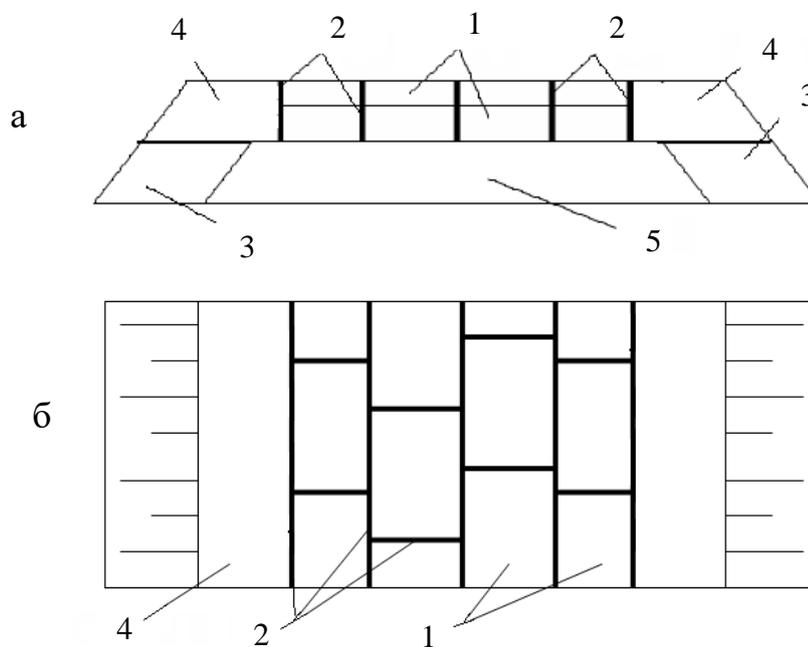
Дорожная одежда из плиты сборного покрытия из асфальтобетона, армированной не менее чем двумя слоями полимерной арматуры: а – поперечный разрез; б – вид сверху; 1 – плита сборного покрытия из асфальтобетона, армированной не менее чем двумя слоями полимерной арматуры; 2 – армированные яшвы, заполненные мастикой; 3 – обочина из местного грунта; 4 – укрепленная обочина; 5 – основание дорожной одежды
